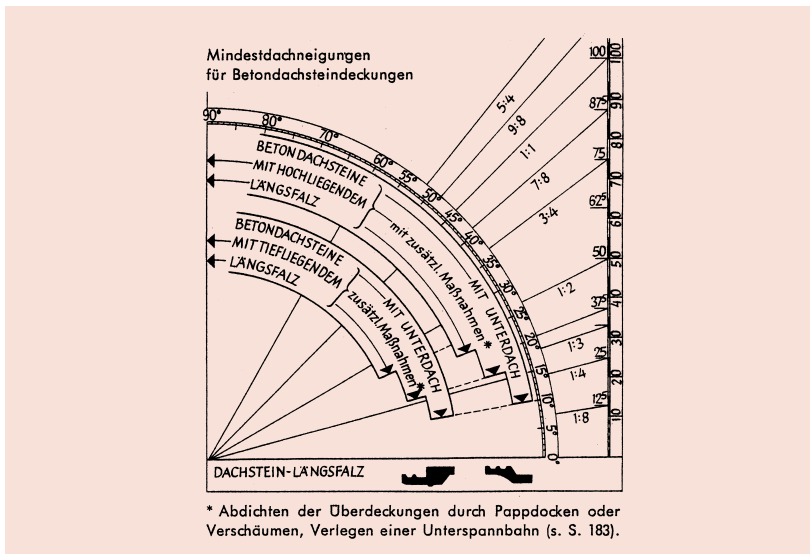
■ Mindestdachneigungen bei Betondachsteinen [1]
